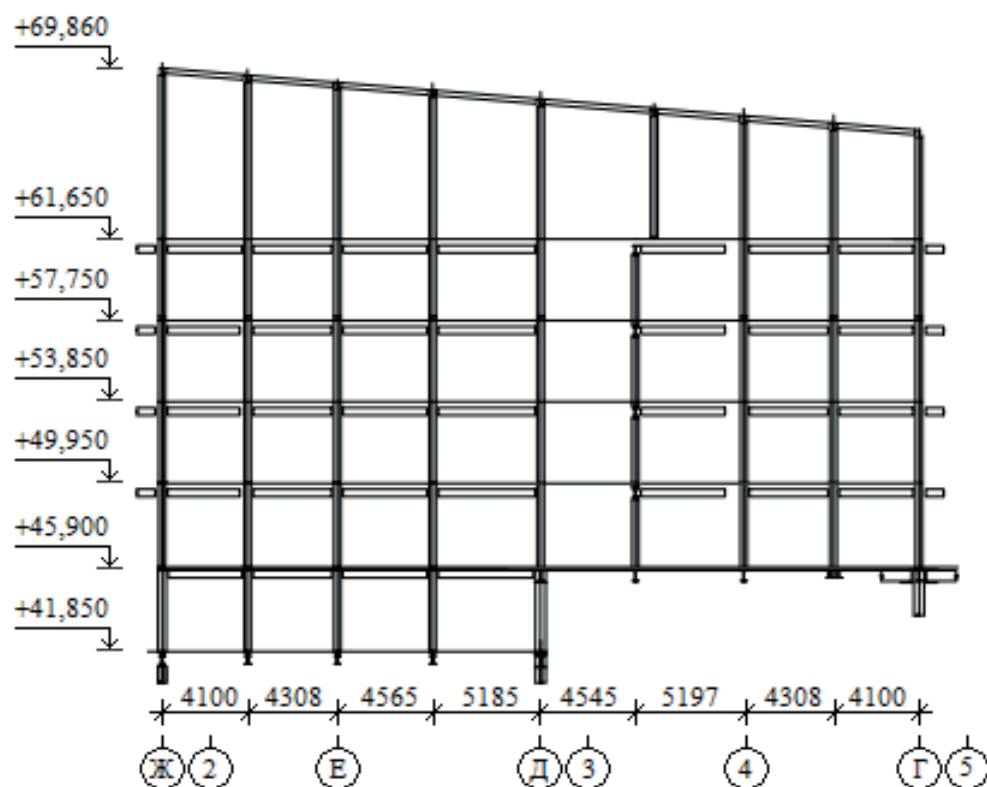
Поперечний переріз офісної надбудови по більшій осі еліпса
